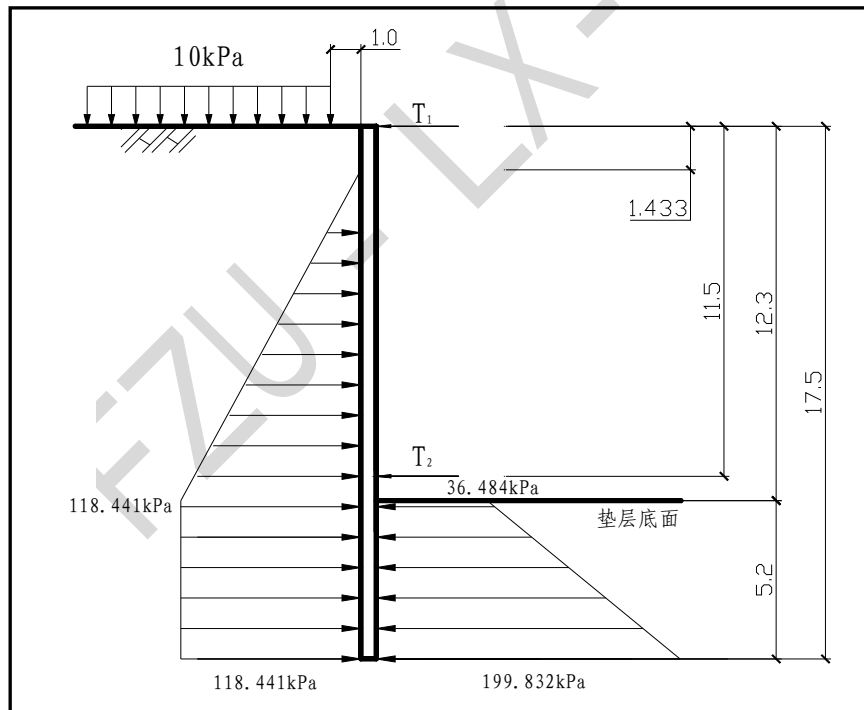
路面设永久支撑力学计算简图(尺寸单位: m)
